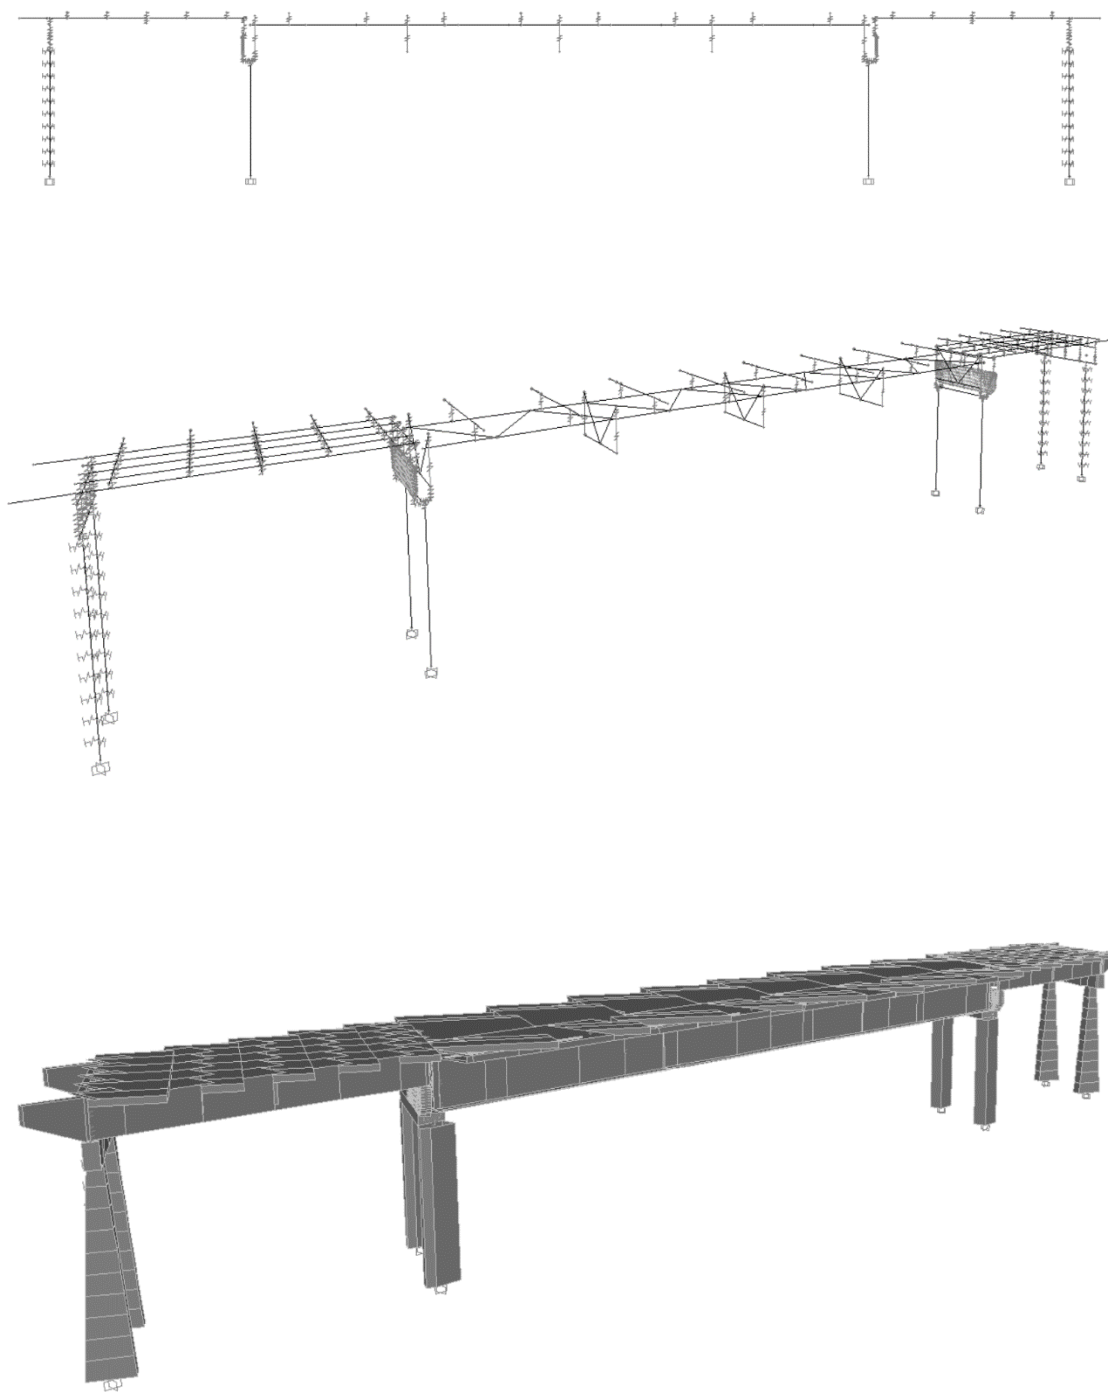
Modello del cavalcavia 357 - Prospetto e viste tridimensionali
